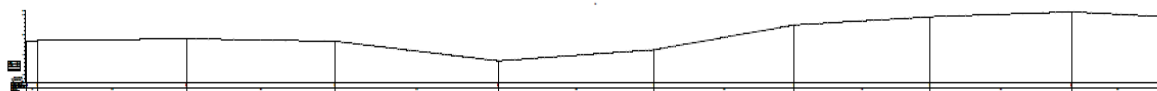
Potongan Melintang Saluran Hilir Sungai Martadah Baru sebagai lokasi Alternatif 1
